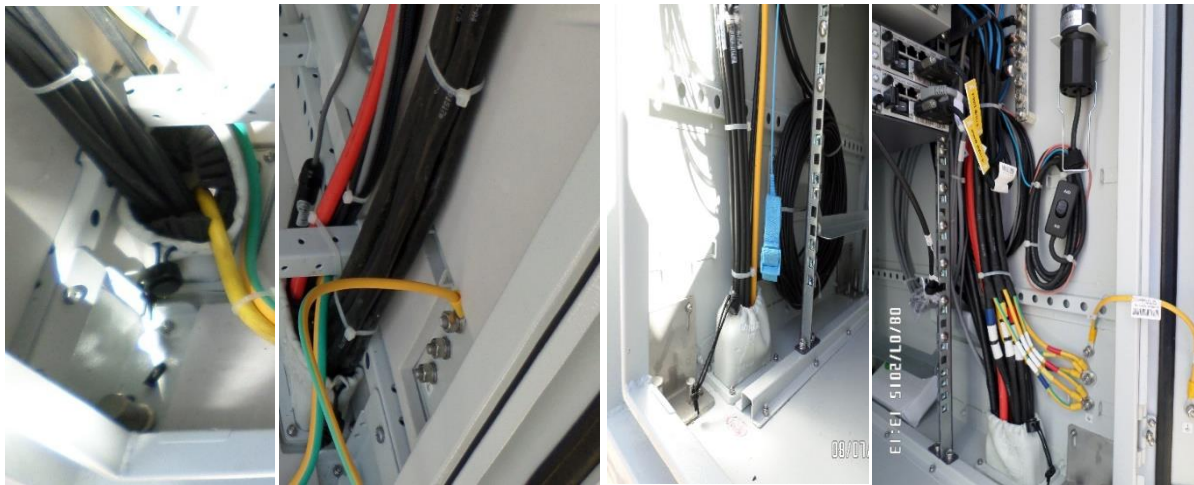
Pasamuro interno de Gabinetes, Site Santa Teresa
